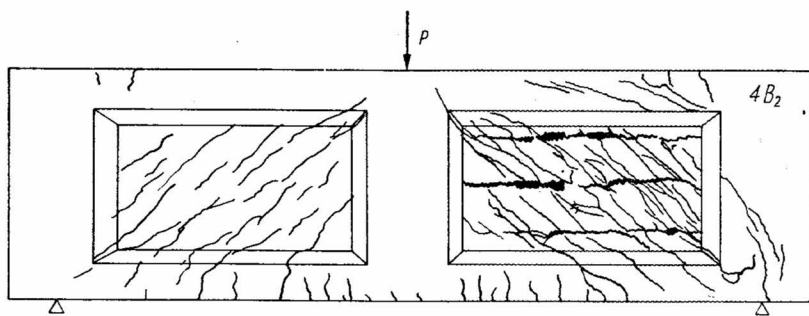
Fissuration de la poutre dont l'armature est représentée sur la figure 5-43d
